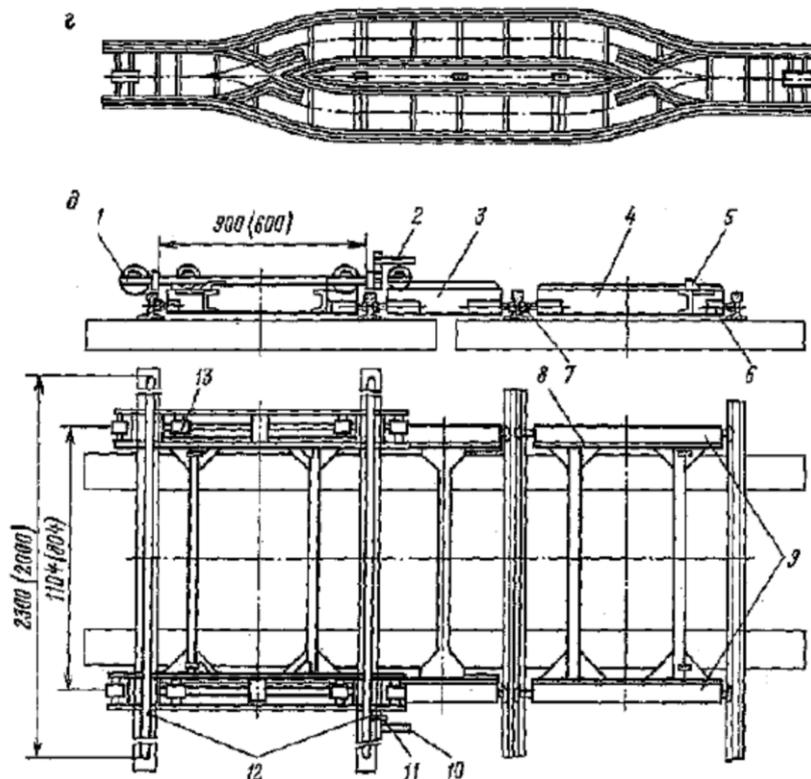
Обменные устройства для вагонеток: г – накладная разминовка; д – перекатная роликовая платформа
